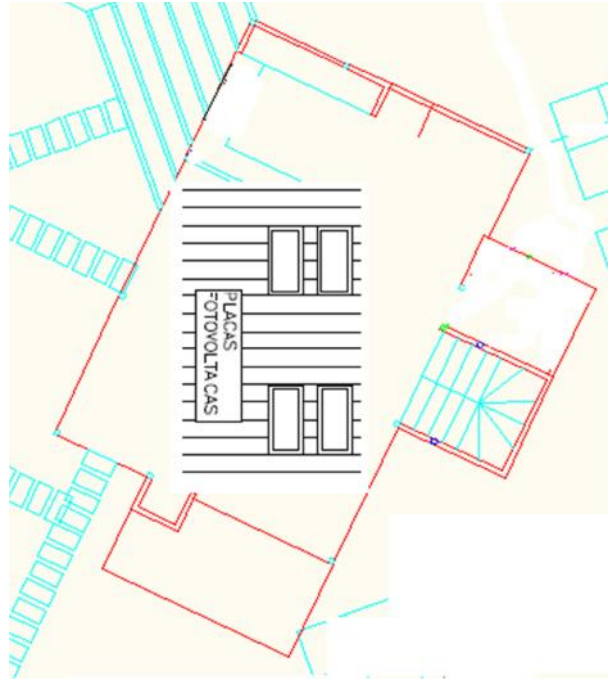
Emplazamiento de los módulos PV sobre la cubierta de la vivienda
